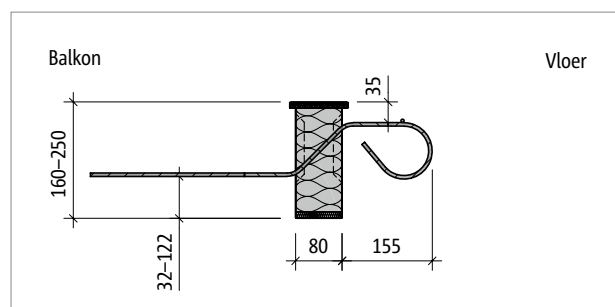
Schöck Isokorf® T type Q-T-W-V1 tot V2: Zijaanzicht
